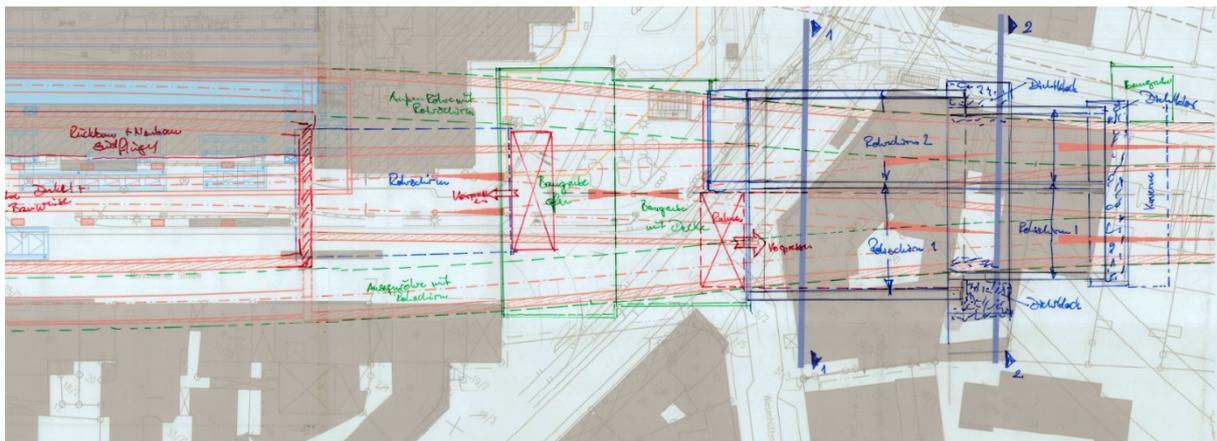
Lageplanausschnitt Verzweigungsbereich Typ B
